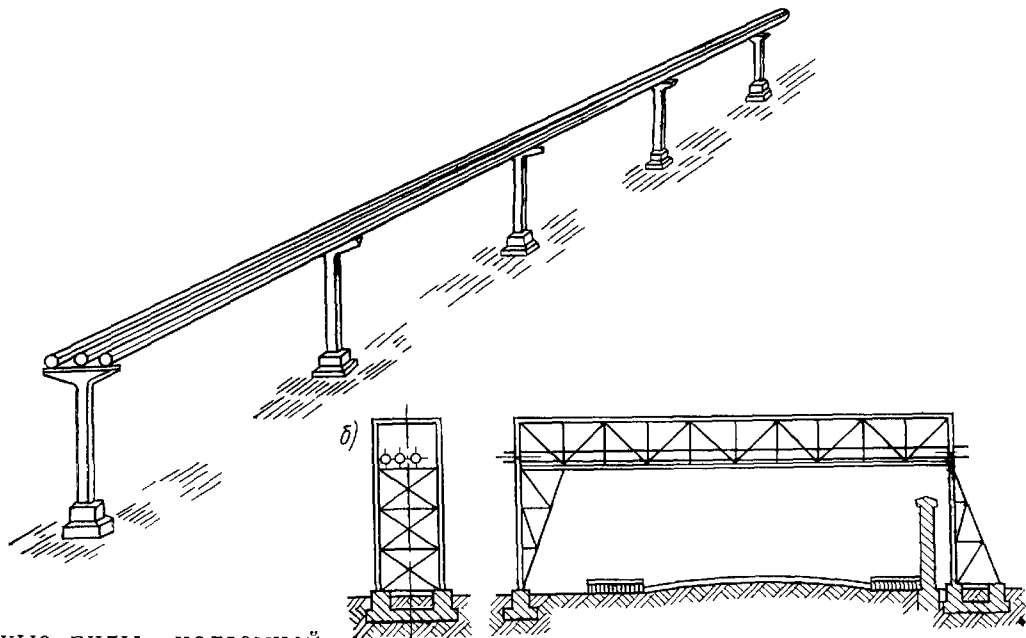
Основные виды надземной прокладки теплопроводов
